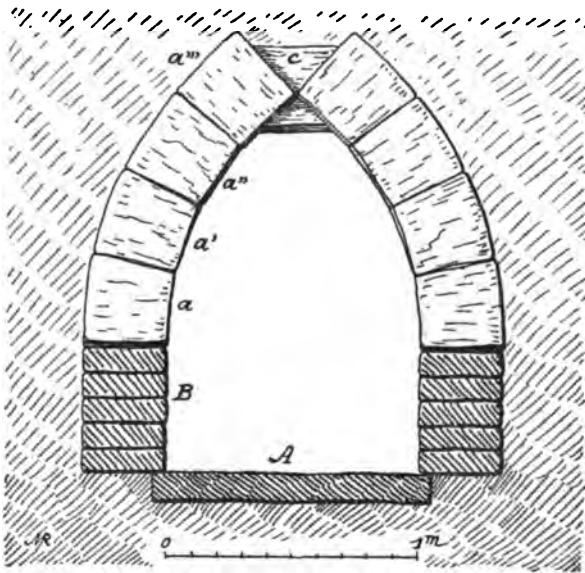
Coupe transversale d'un aqueduc de Khorsabad, (d'après V. Place).
